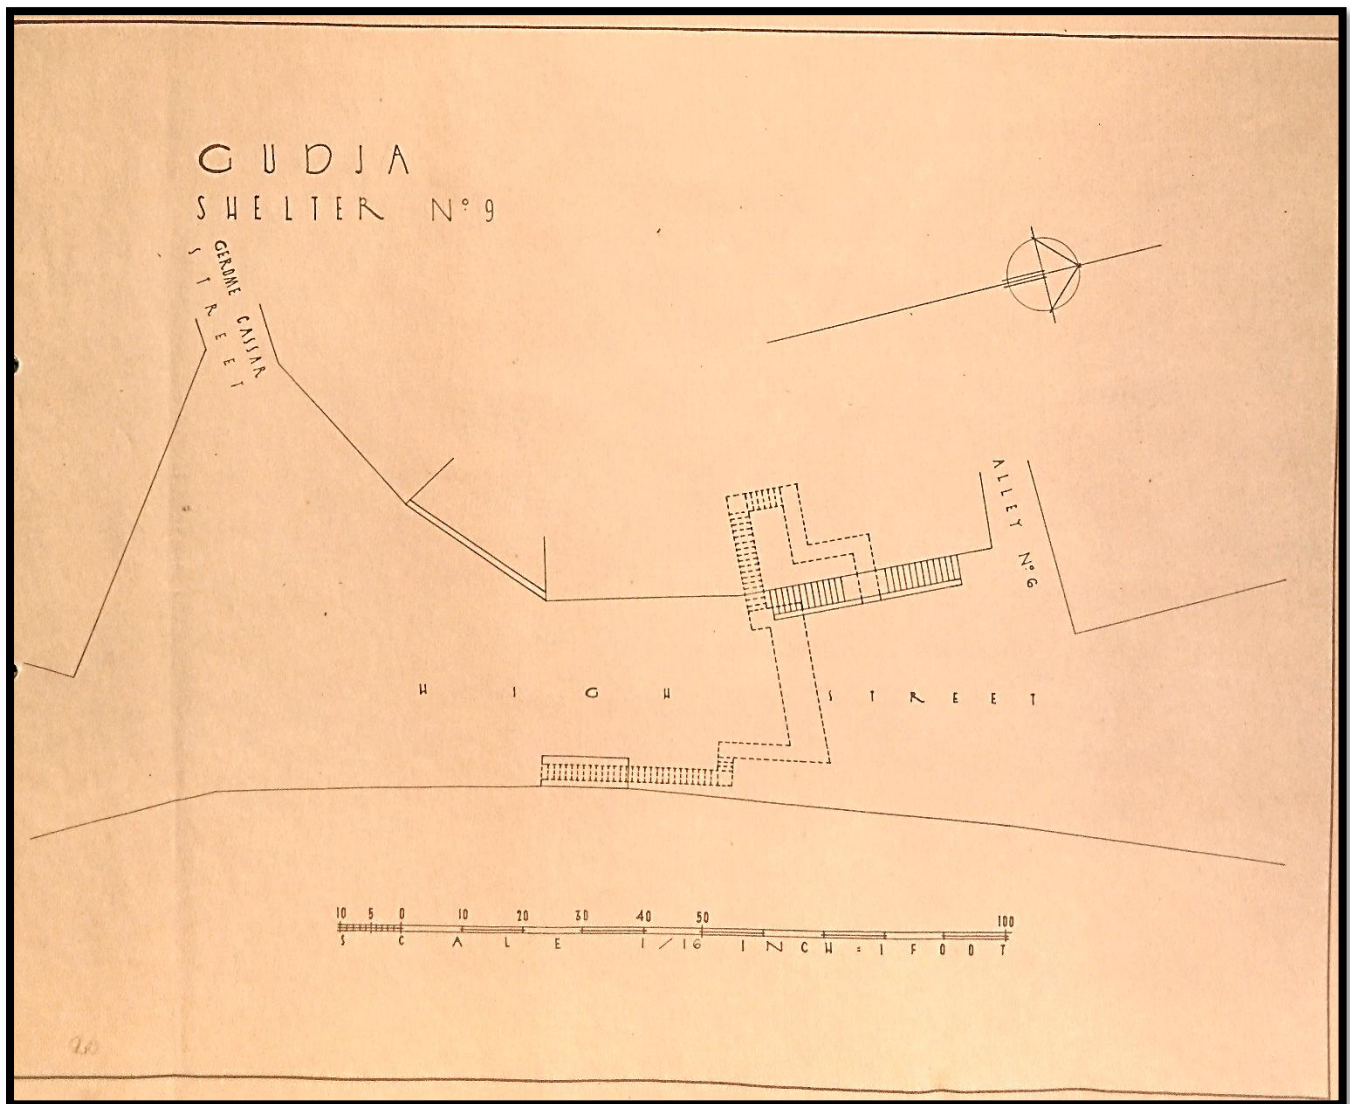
Planta do Abrigo nº9 "Gerome Cassar Street – High Street – Alley nº6."
